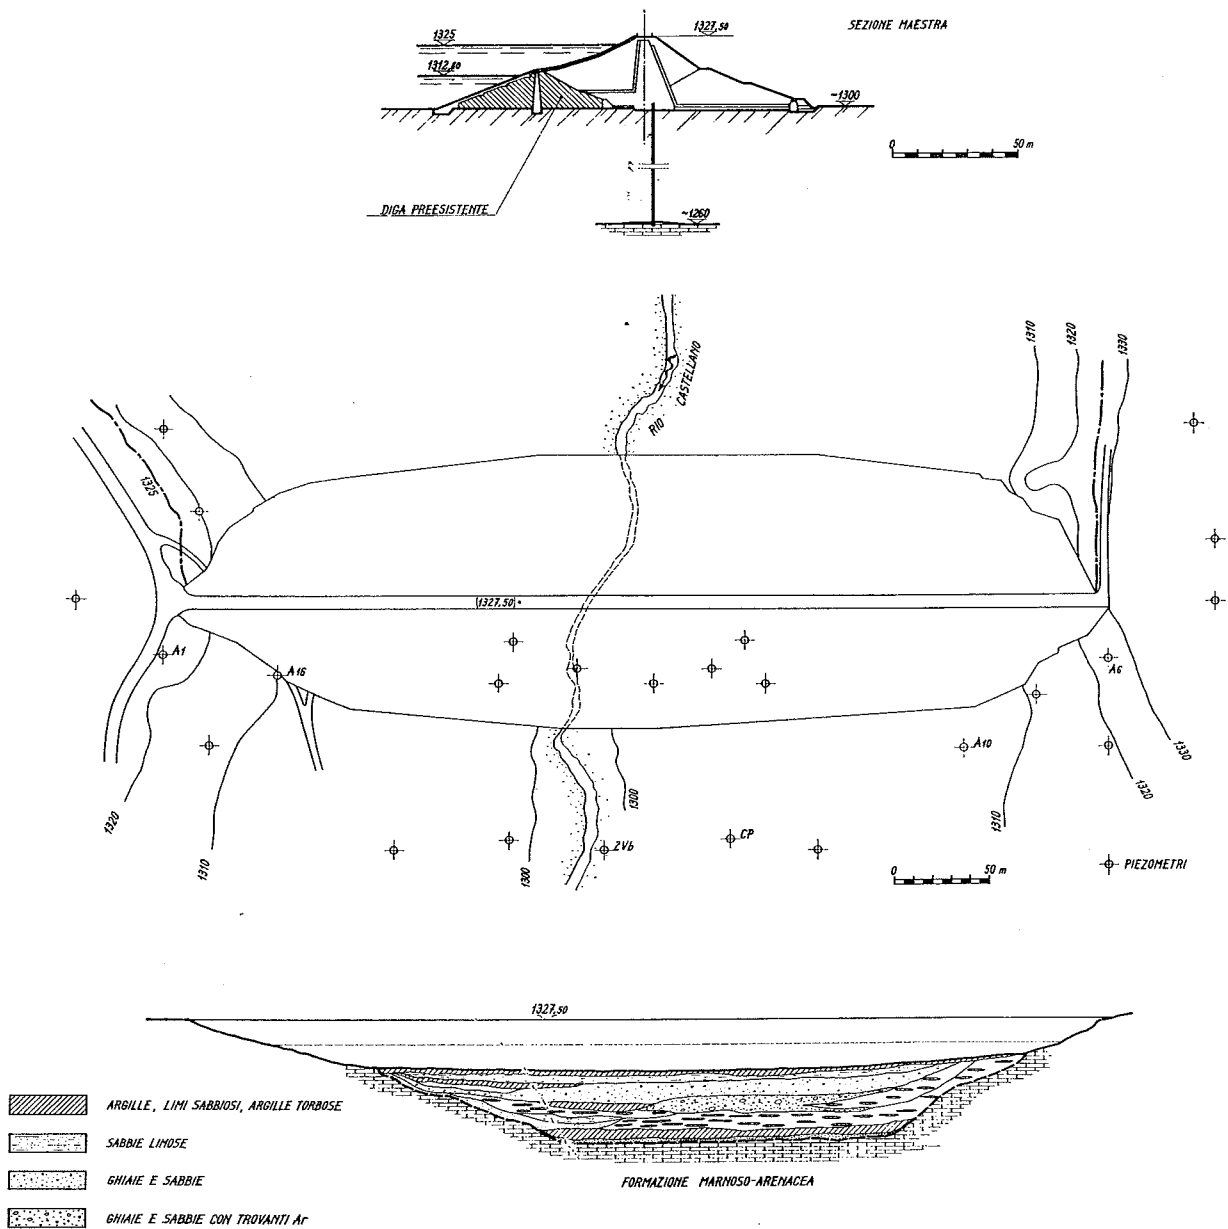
Sopraelevazione della diga di Poggio Cancelli.
